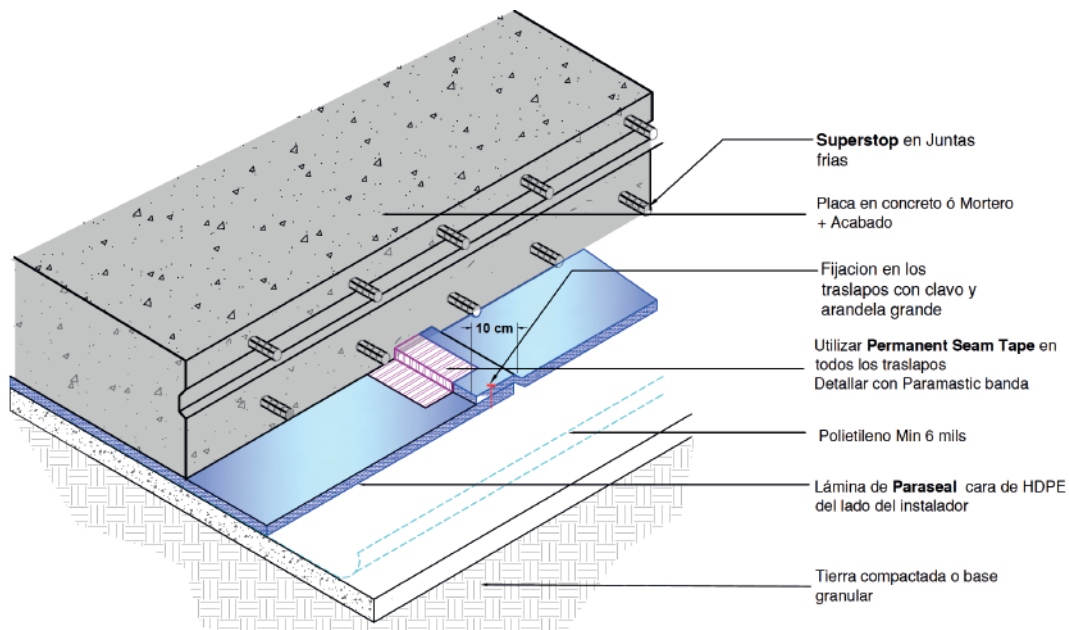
Detalle PARASEAL STD/LG en placas de contrapiso.
